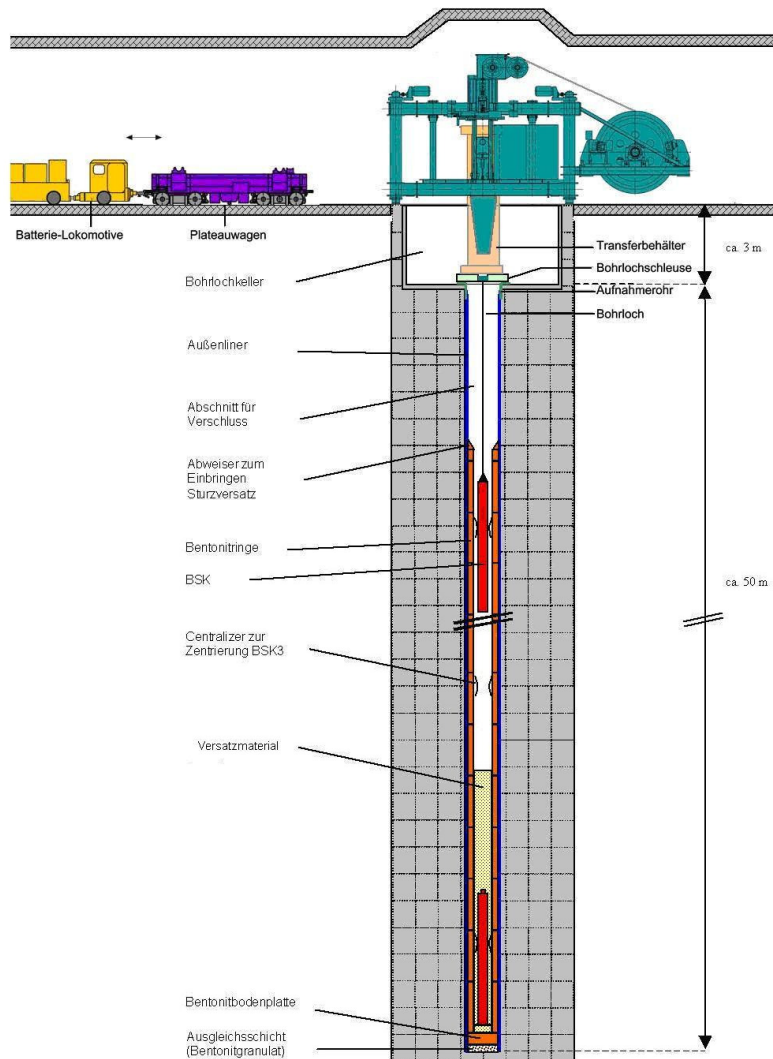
Einlagerungsvorgang der Brennstabkokille im Ton
